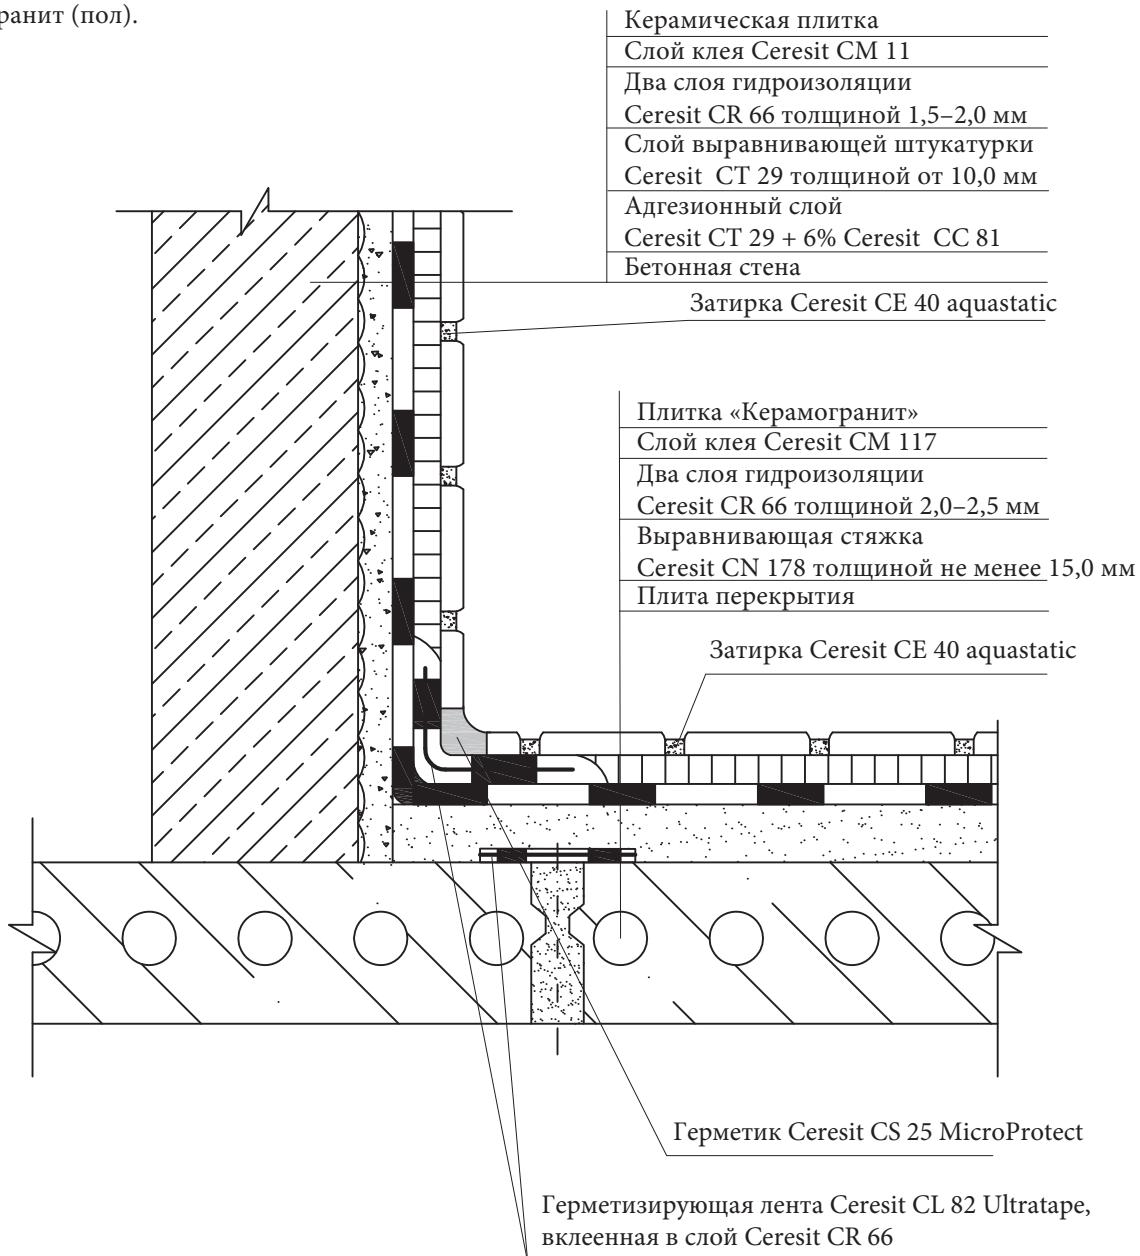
Конструкция системы гидроизоляции для производственных душевых помещений, расположенных на плитах перекрытия
